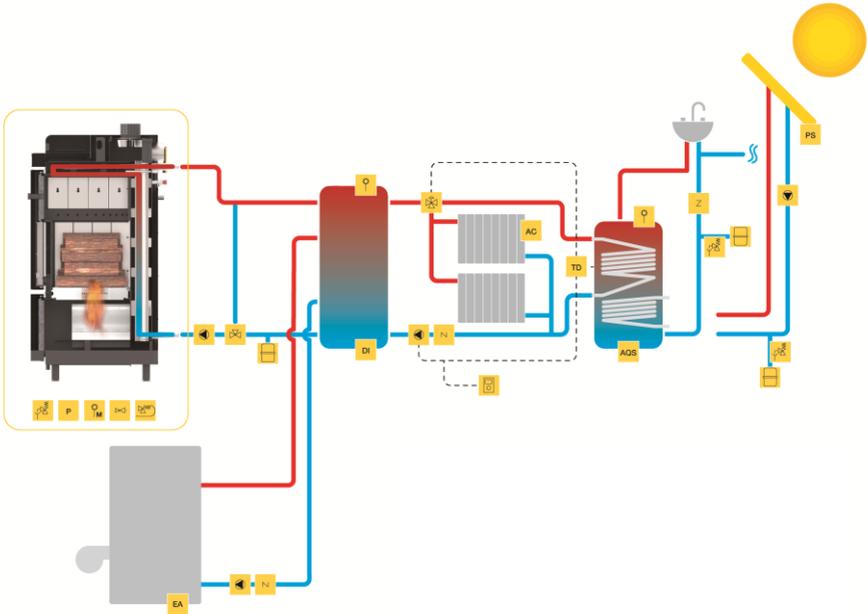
Esquema de instalação para aquecimento central, AQS e painel solar com apoio de caldeira a pellets.
